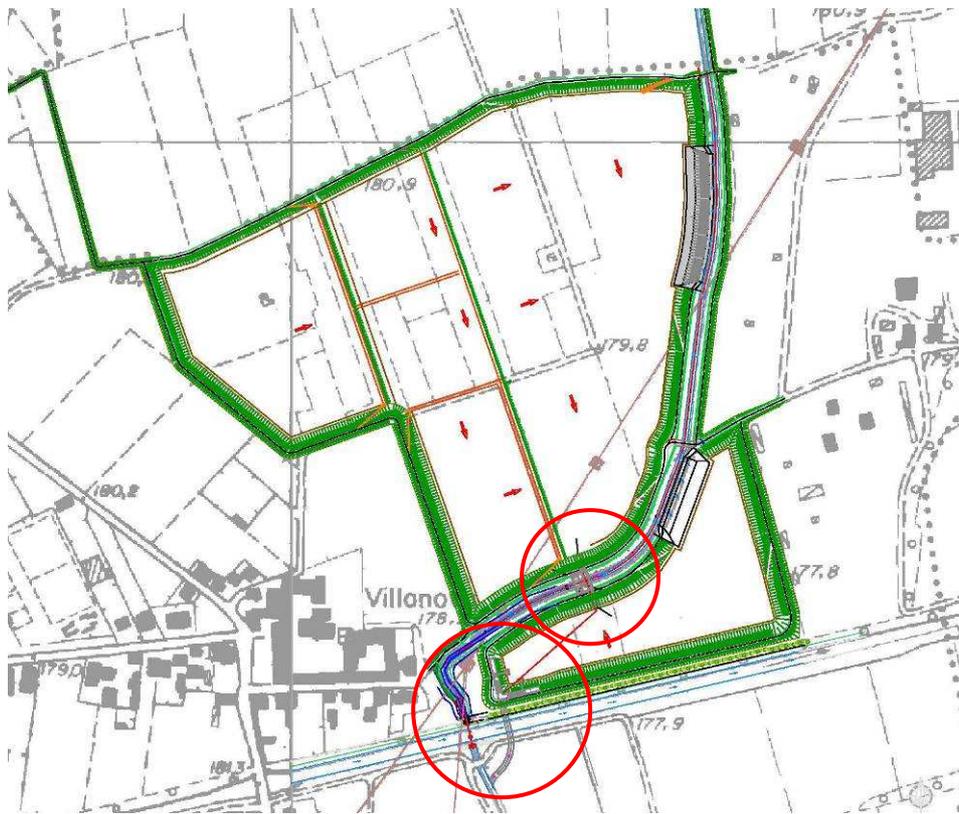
particolare planimetria dell'area di laminazione come da progetto definitivo settembre 2014
